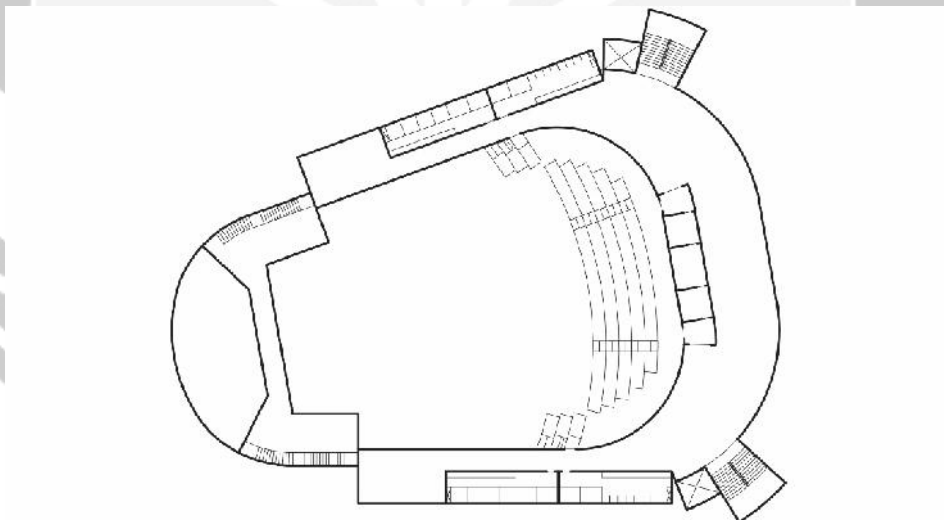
Denah Skematik *basement* Gedung Pertunjukan
